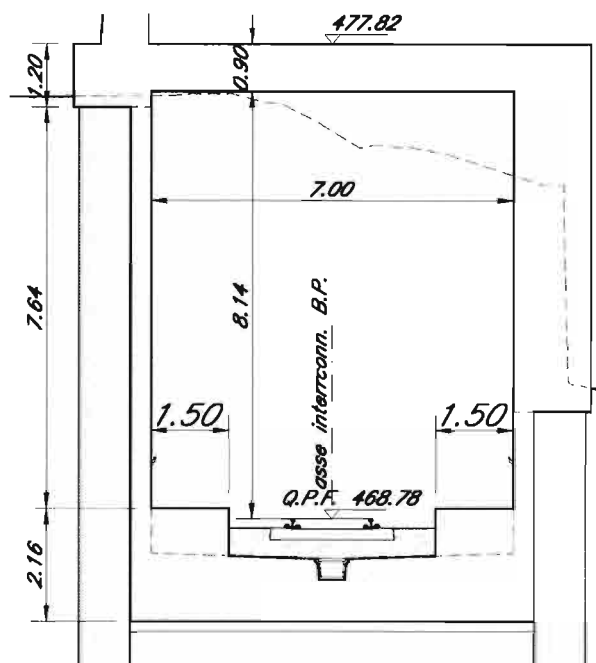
Sezione tipo di intradosso in galleria artificiale dell'Interconnessione di Ponte Gardena BP.
